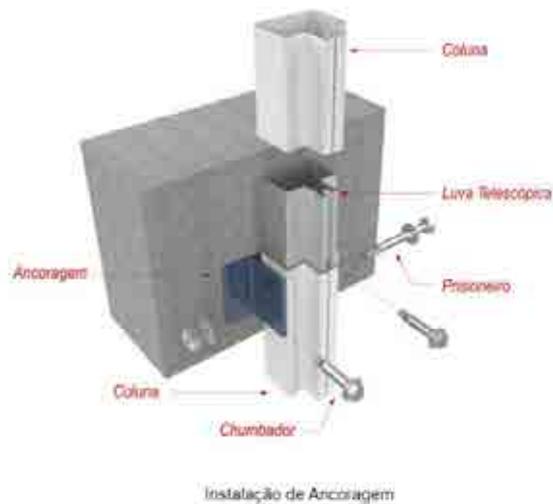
Instalação de Ancoragem na estrutura principal da edificação
